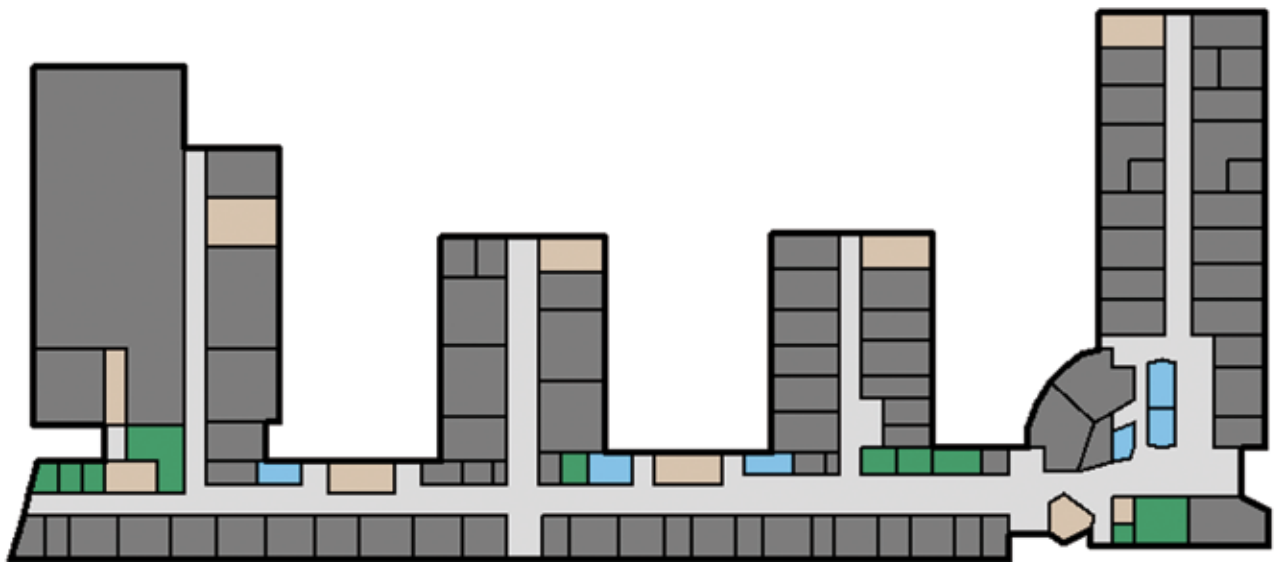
Grundriss des UFT – die Labortrakte (oben) weisen nach Norden, der Bürobereich (unten) ist nach Süden ausgerichtet.
